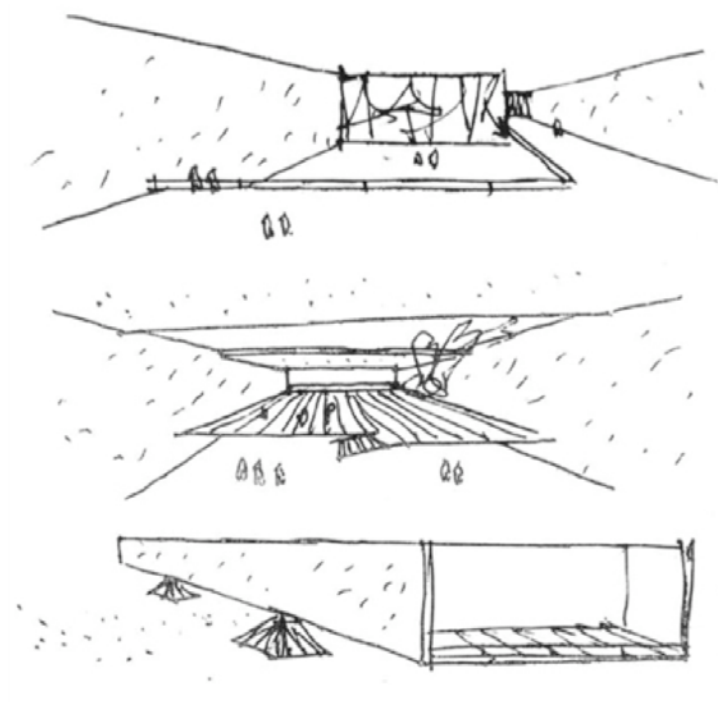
Museu da Civilização (1962) – interiores e volumetria – croquis.
